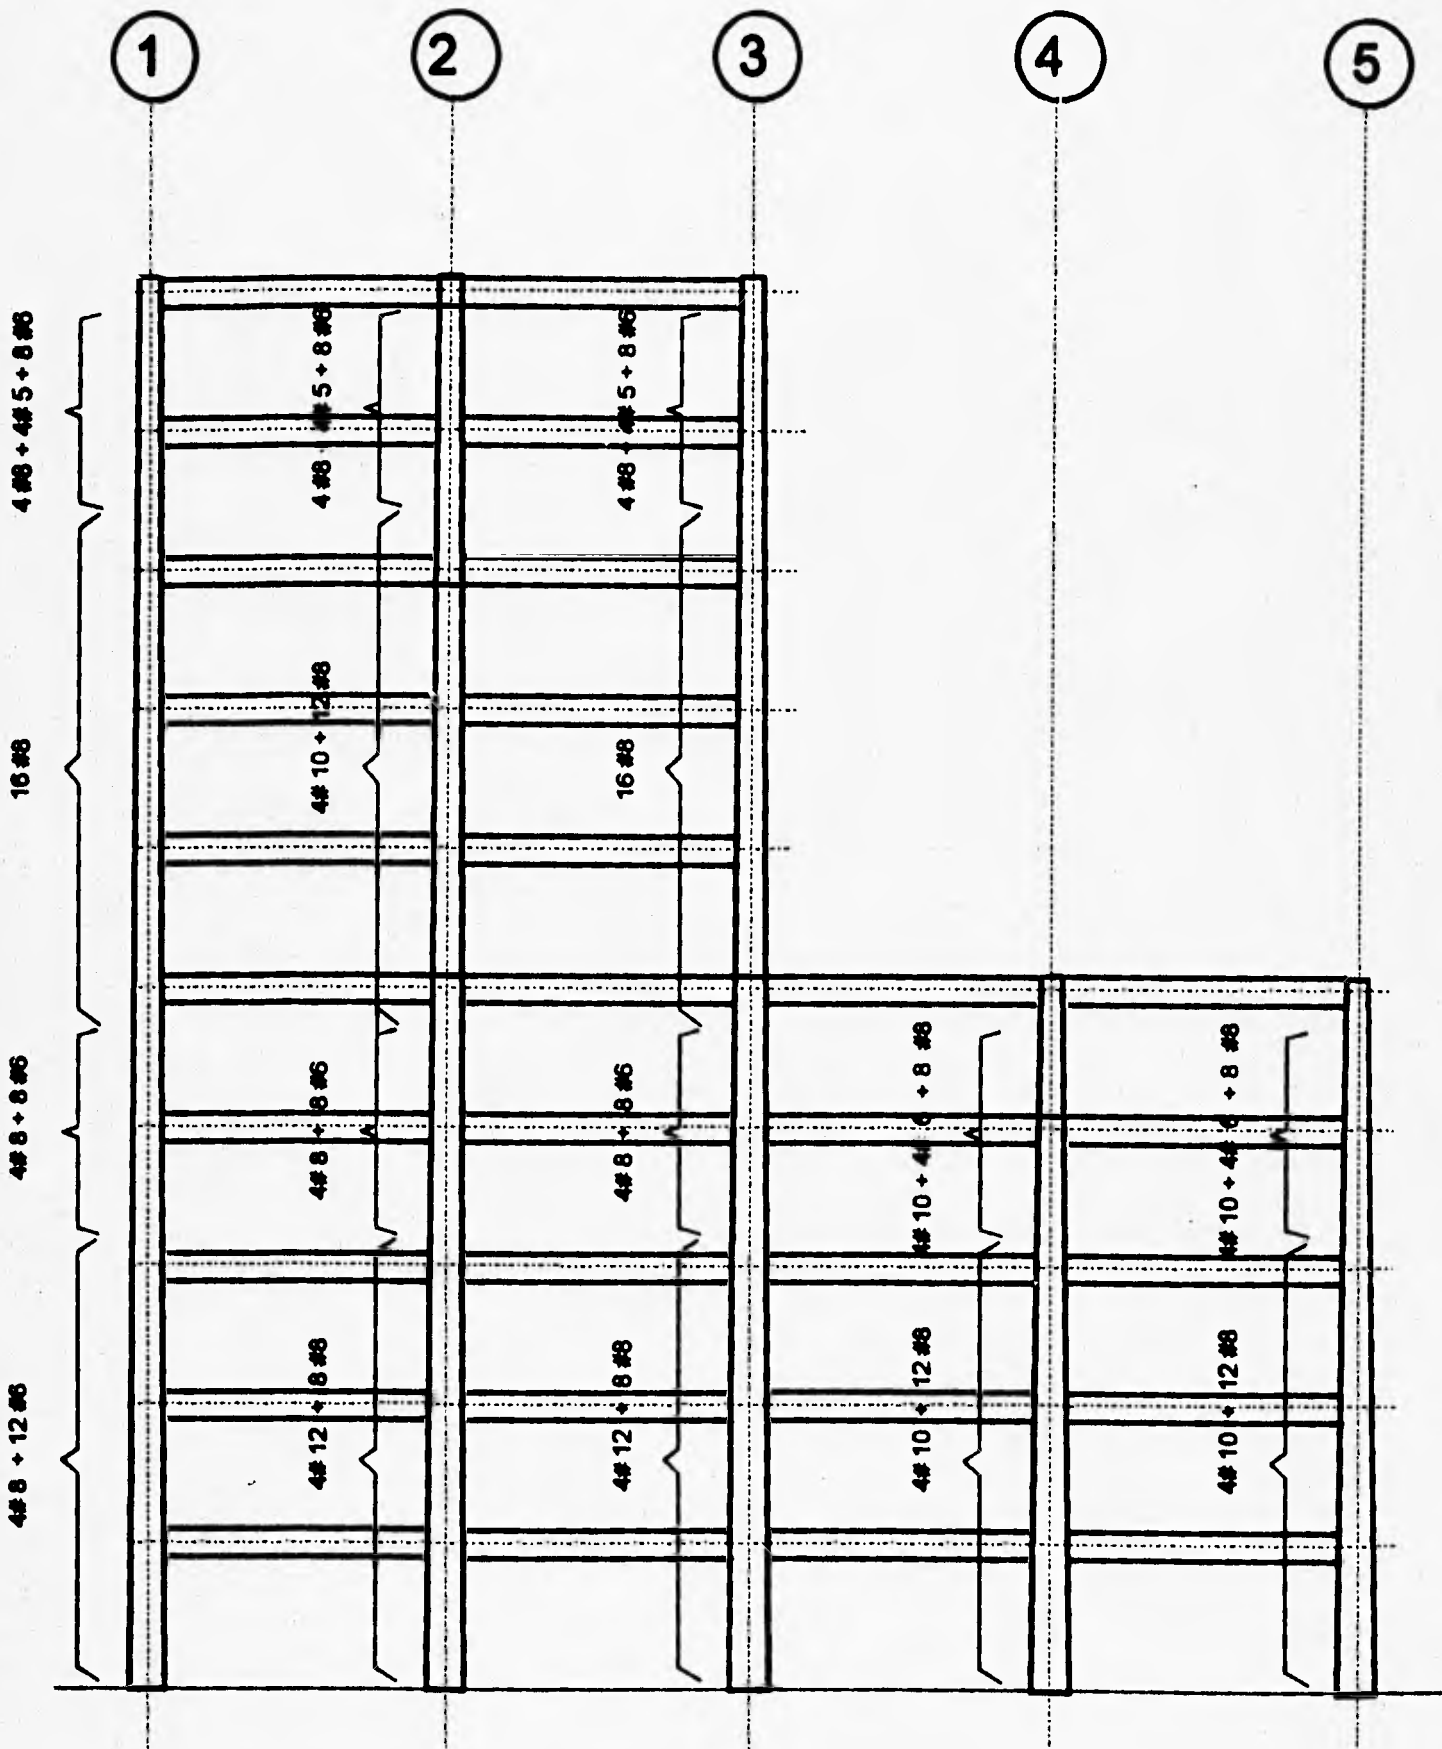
Distribución del Refuerzo Longitudinal en Columnas, Primer Modelo, Q = 2.0
